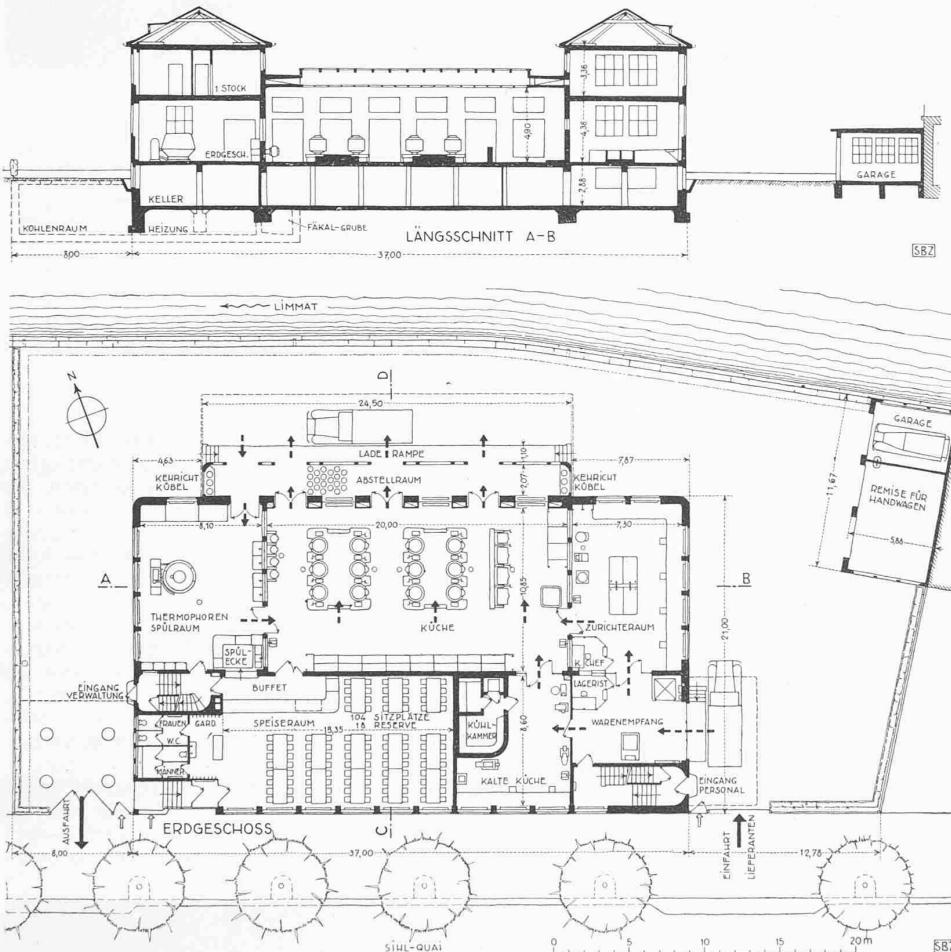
und 2. Grundriss vom Erdgeschoss und Längsschnitt A-B. — Masstab 1:450
